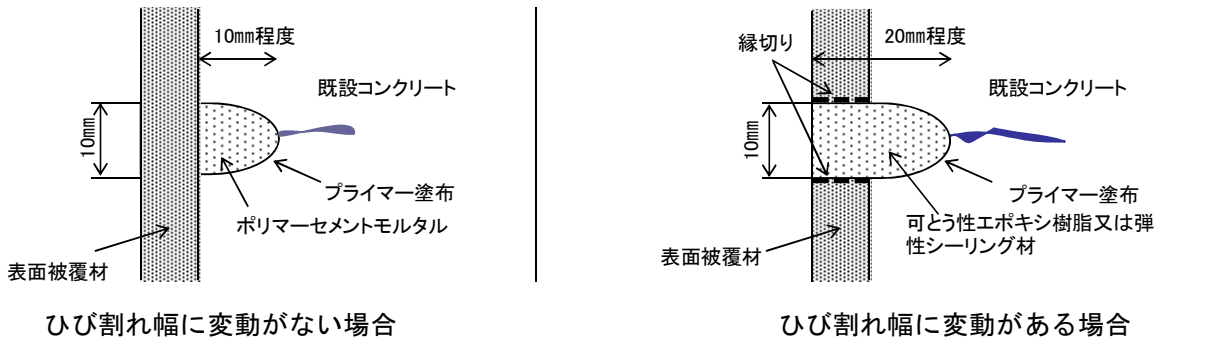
無機系被覆工法とひび割れ充填工法を併用する場合の施工事例
